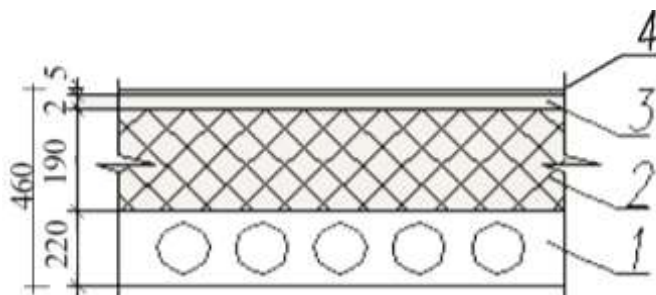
Схема ограждающей конструкции (перекрытие над неотапливаемым подвалом). 4 – слой линолеума, 3 –стяжка, 2 – минираловатная плита, 1 – пустотная плита перекрытия
